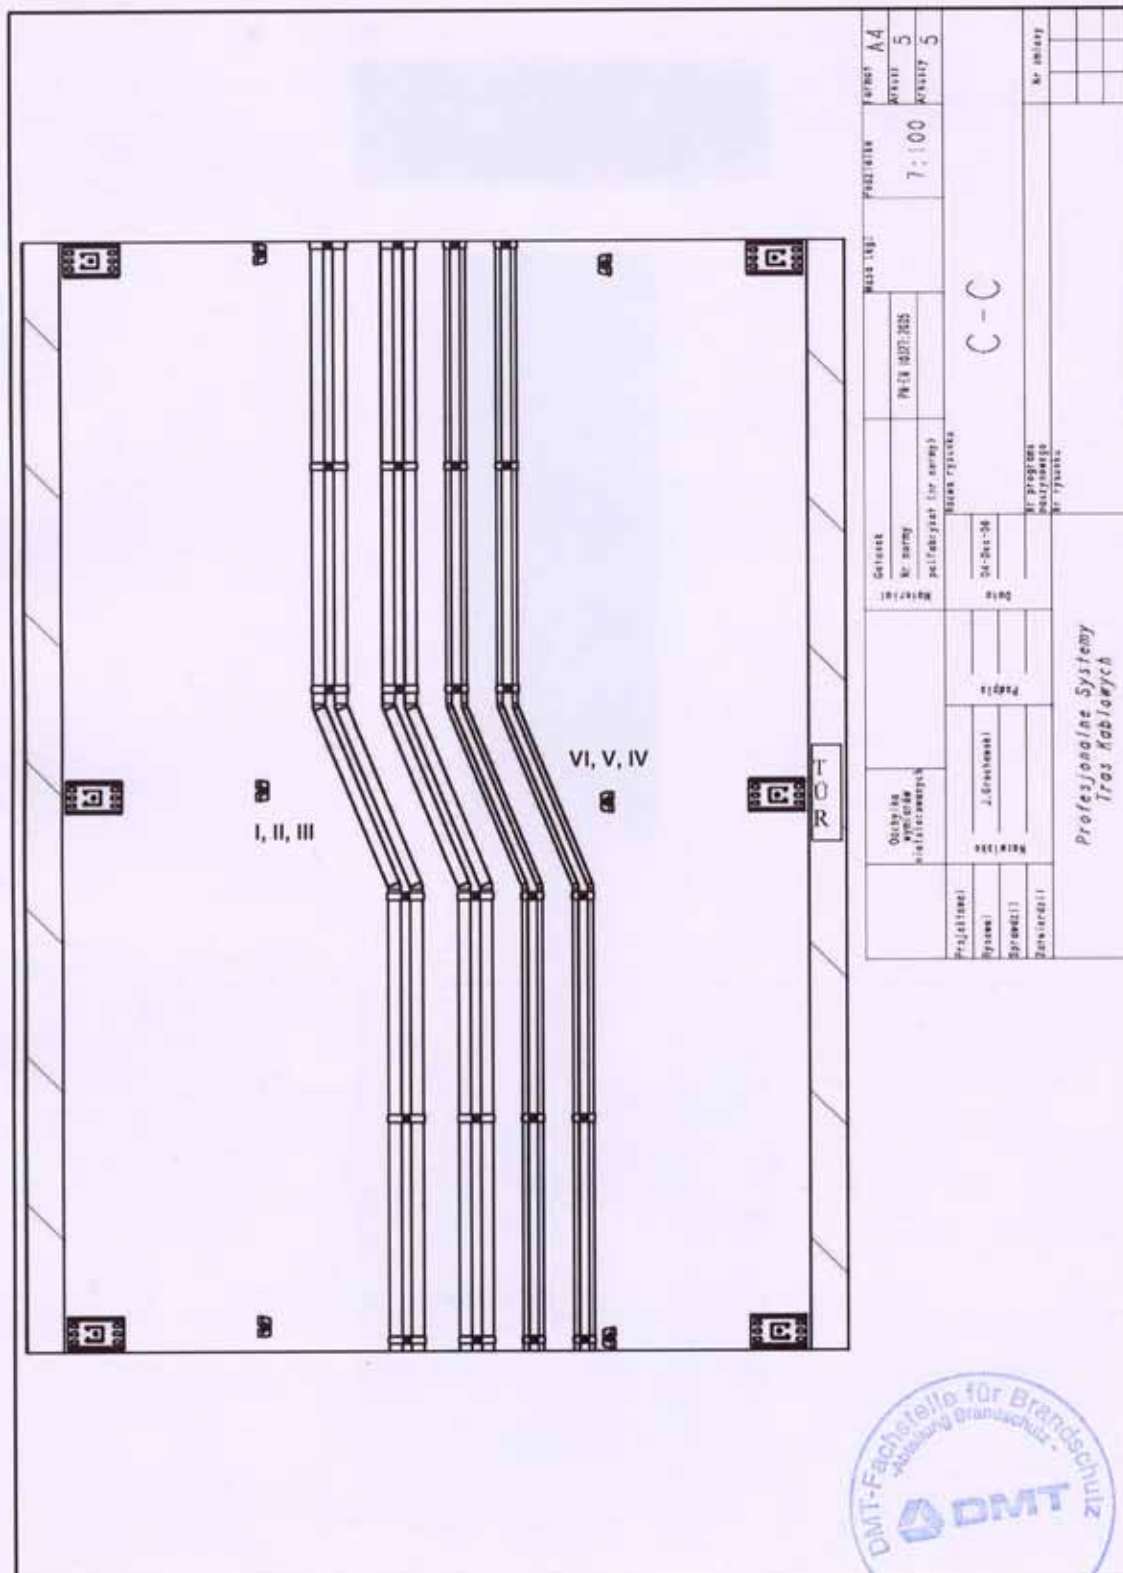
Lage der Thermoelemente im Grundriss
